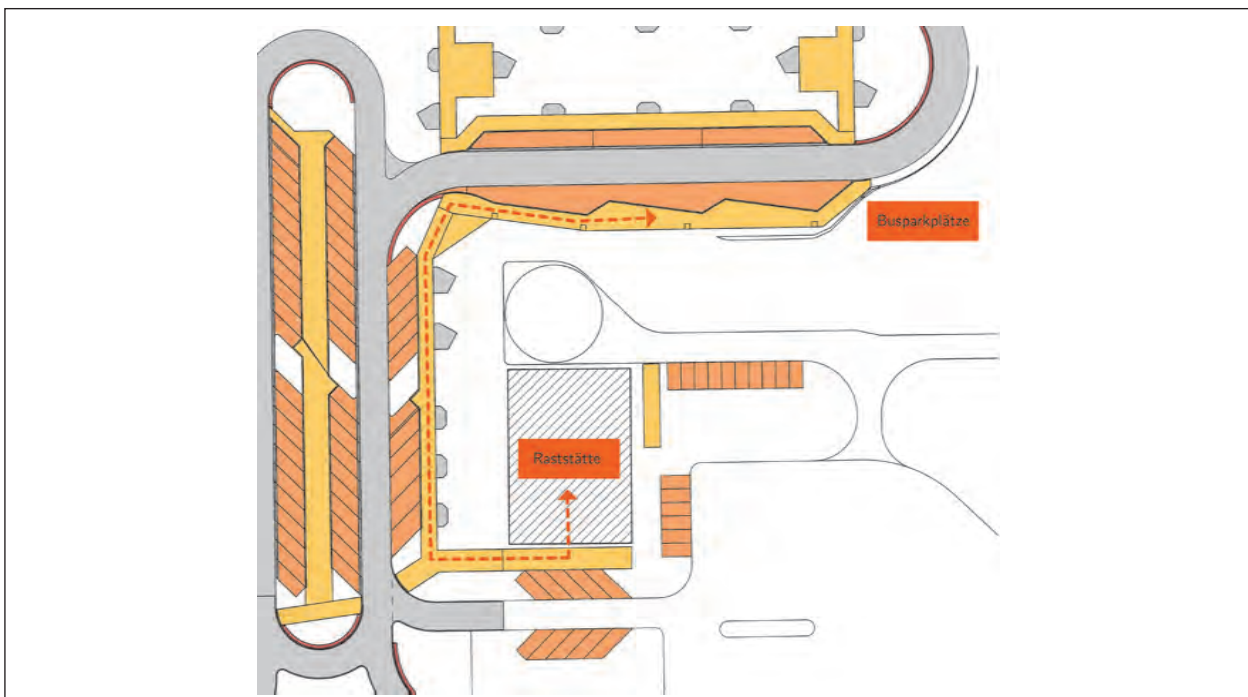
Lageplan (Ausschnitt) einer Rastanlage mit Busparkplätzen mit Ausstieg auf dem Gehweg und direkter Führung zur Raststätte (Quelle: Straßen NRW, bearbeitet durch STUVA)
